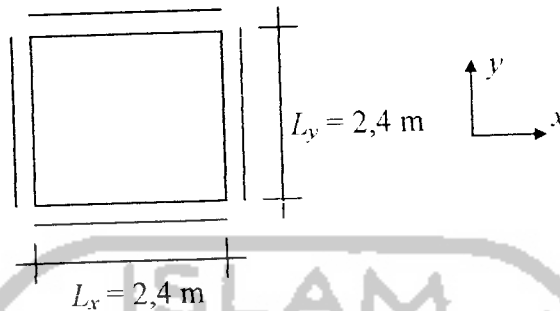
Denah pelat atap (skala: 1 : 280)
